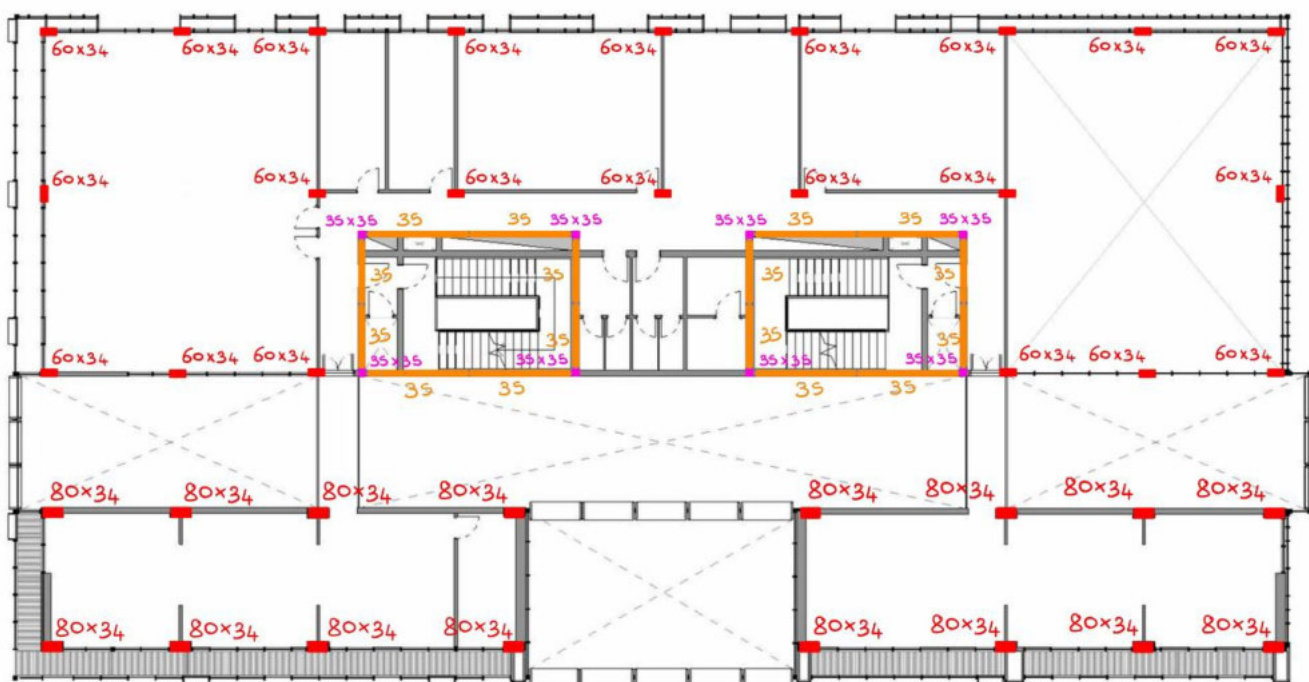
Disposizione in pianta dei pilastri e corpi scala in CLT in pianta e sezione degli elementi
